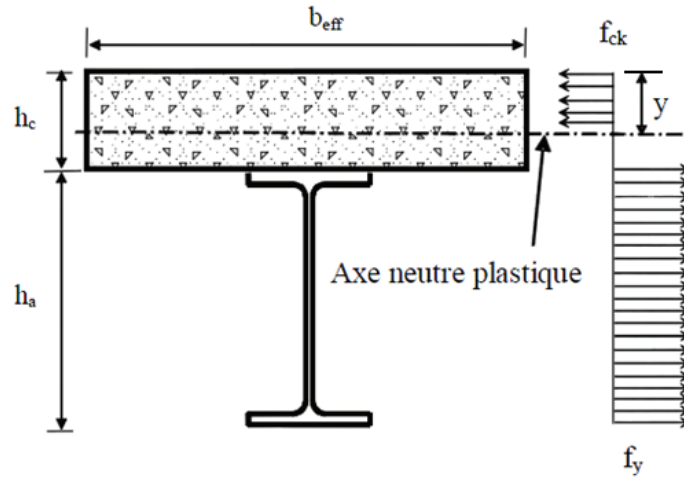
Axe neutre plastique de la poutre mixte dans la dalle
